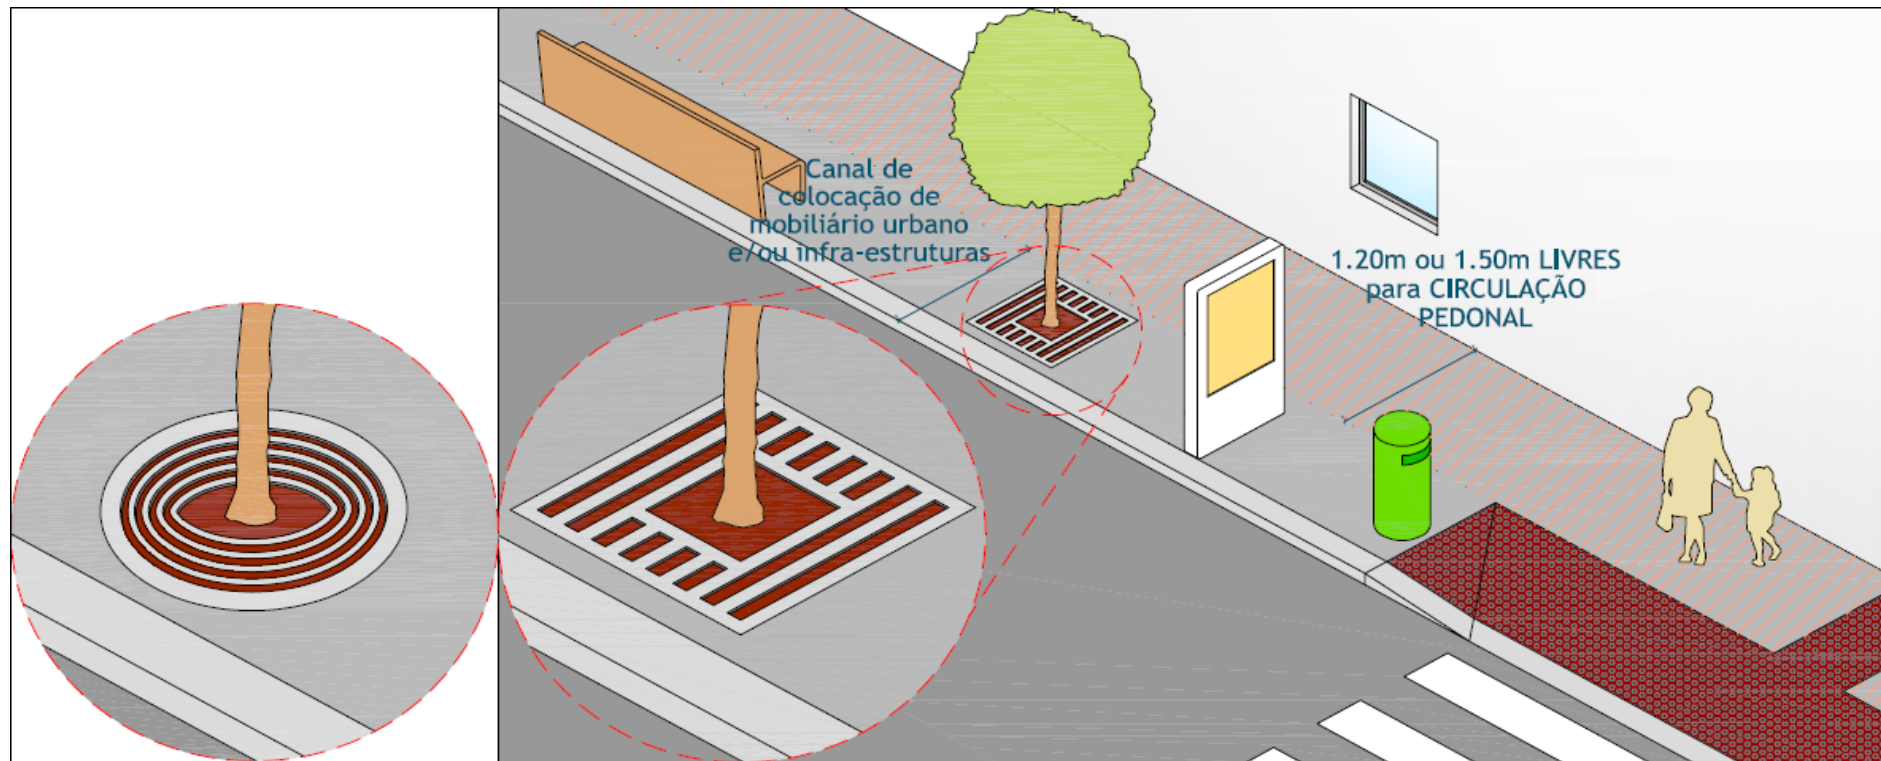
| Passeio corretamente dimensionado e organizado. A sua estrutura contempla dois canais distintos – um para circulação pedonal e outro para infraestruturas.
